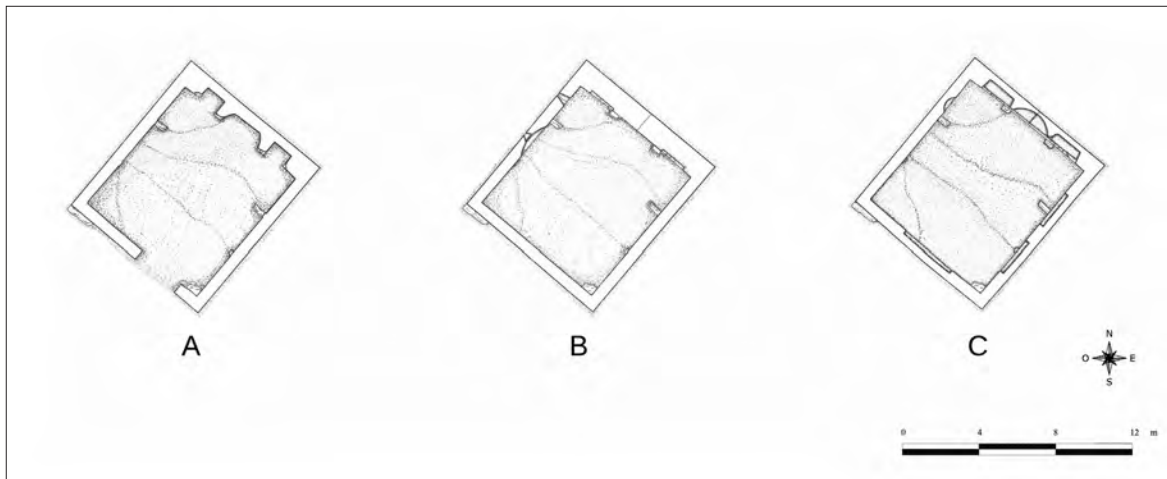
Pianta dell'edificio a +0,50 m (A), +4,00 m (B) e a +6,00 m (C) rispetto al piano di campagna (dis. C. Fasciani, F. Salamone).
